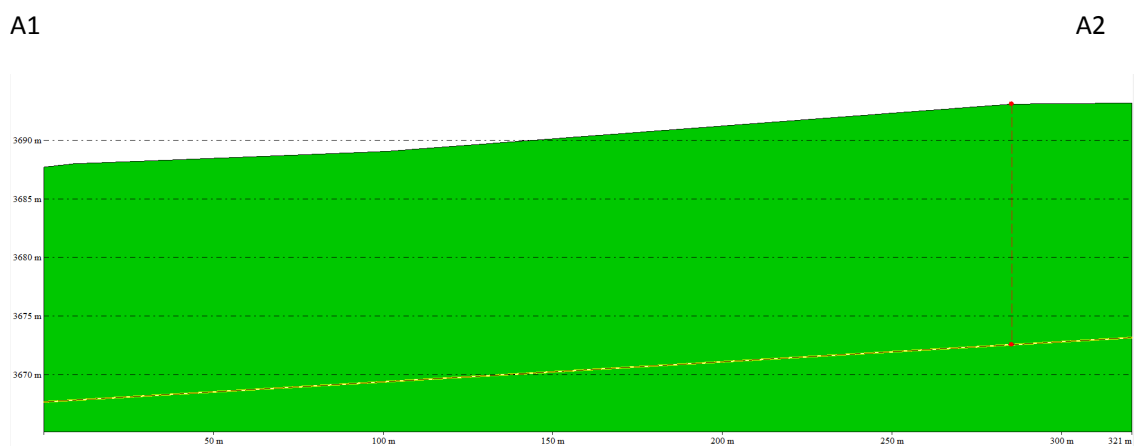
PERFIL DE ELEVACIÓN A1-A2
